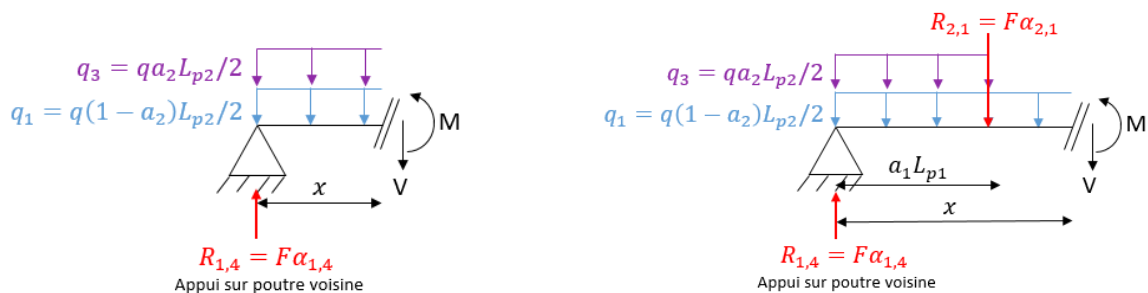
Poutre type 1 – coupe 1 (gauche) et coupe 2 (droite)
